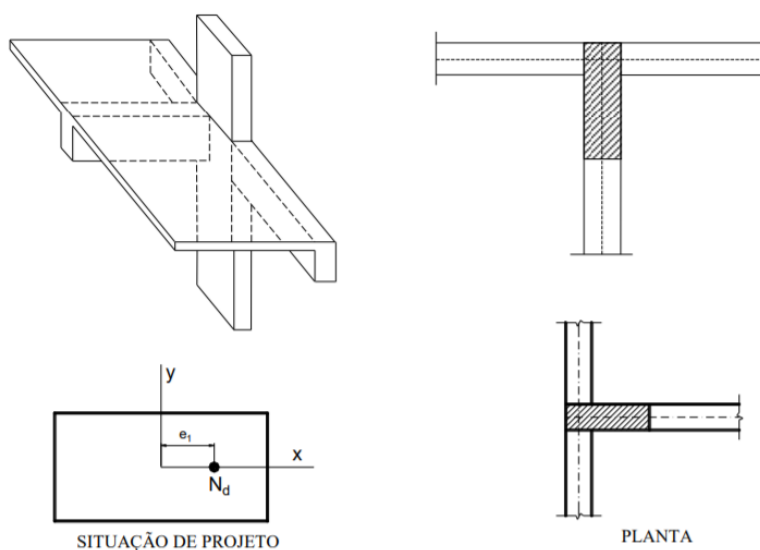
Arranjo estrutural e situação de projeto de pilar intermediário.
